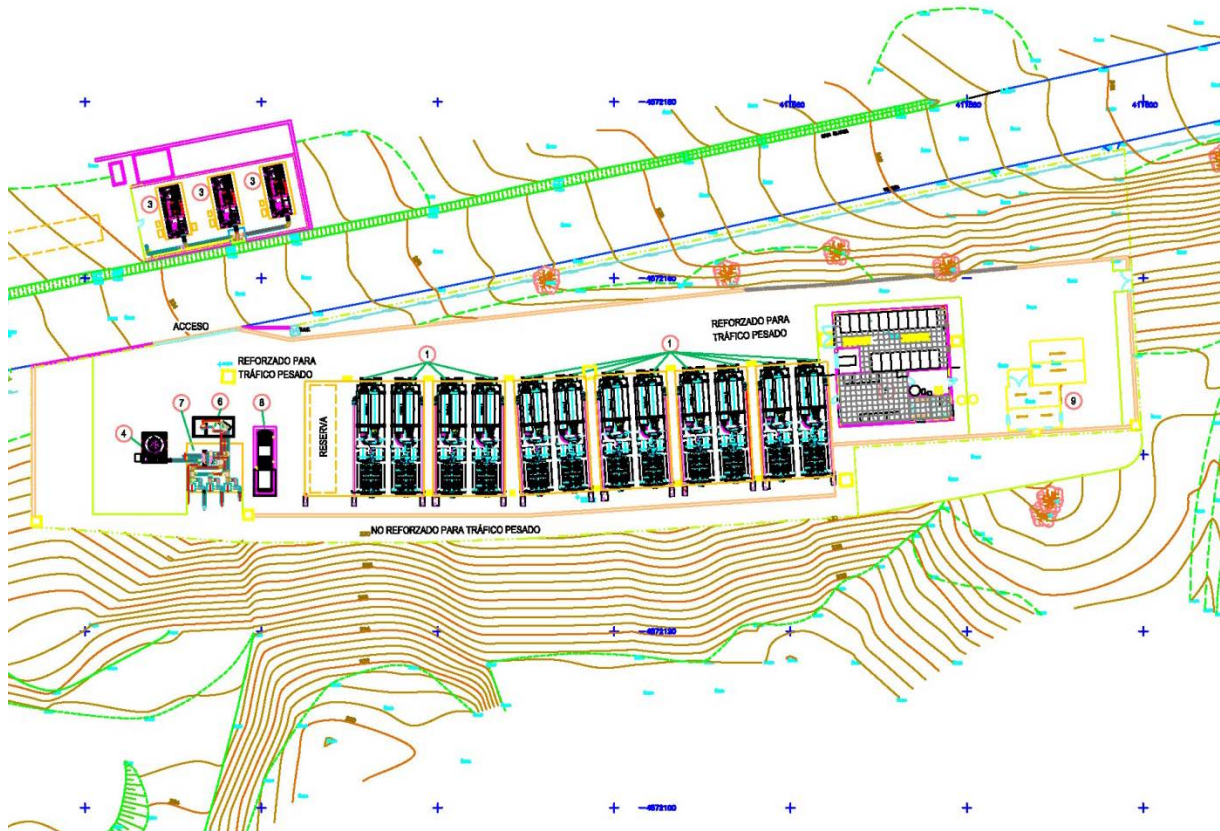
Plano de las instalaciones de TERSA en el Vertedero Controlado de la Vall d'en Joan
